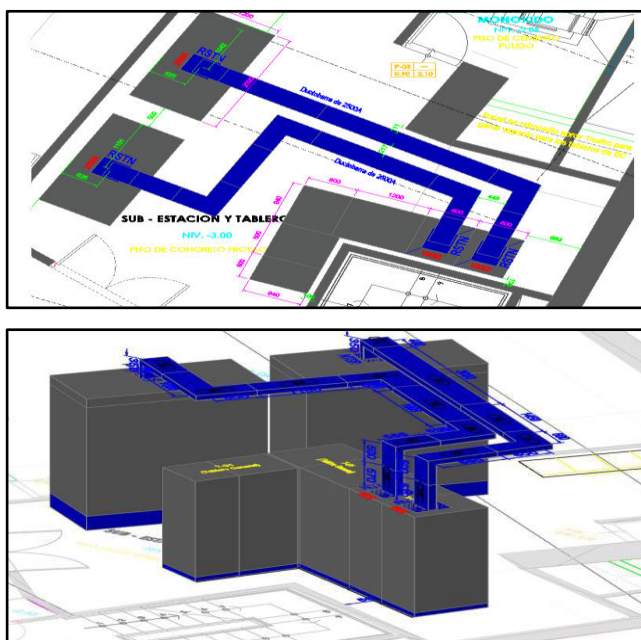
Vista de planta e isométrica de ducto de barras N°5 y 6. Fuente: (Manufacturas Electricas, s.f.)
